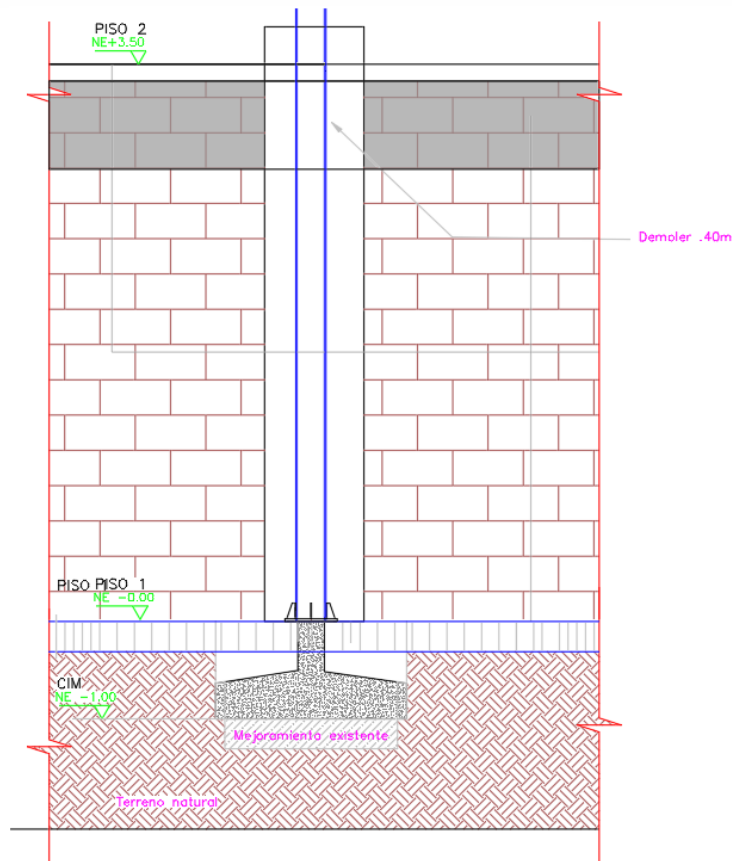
Demolición para Instalación de Vigas Metálica.
